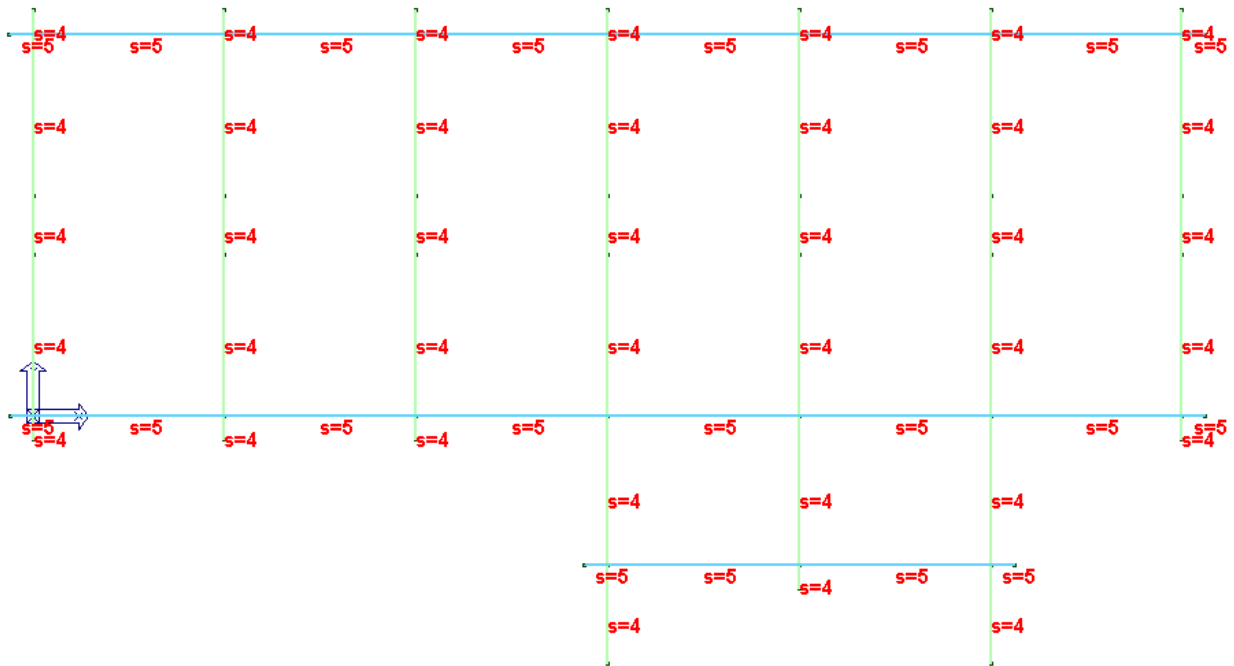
2 – Codice “Id”elementi strutturali in fondazione
